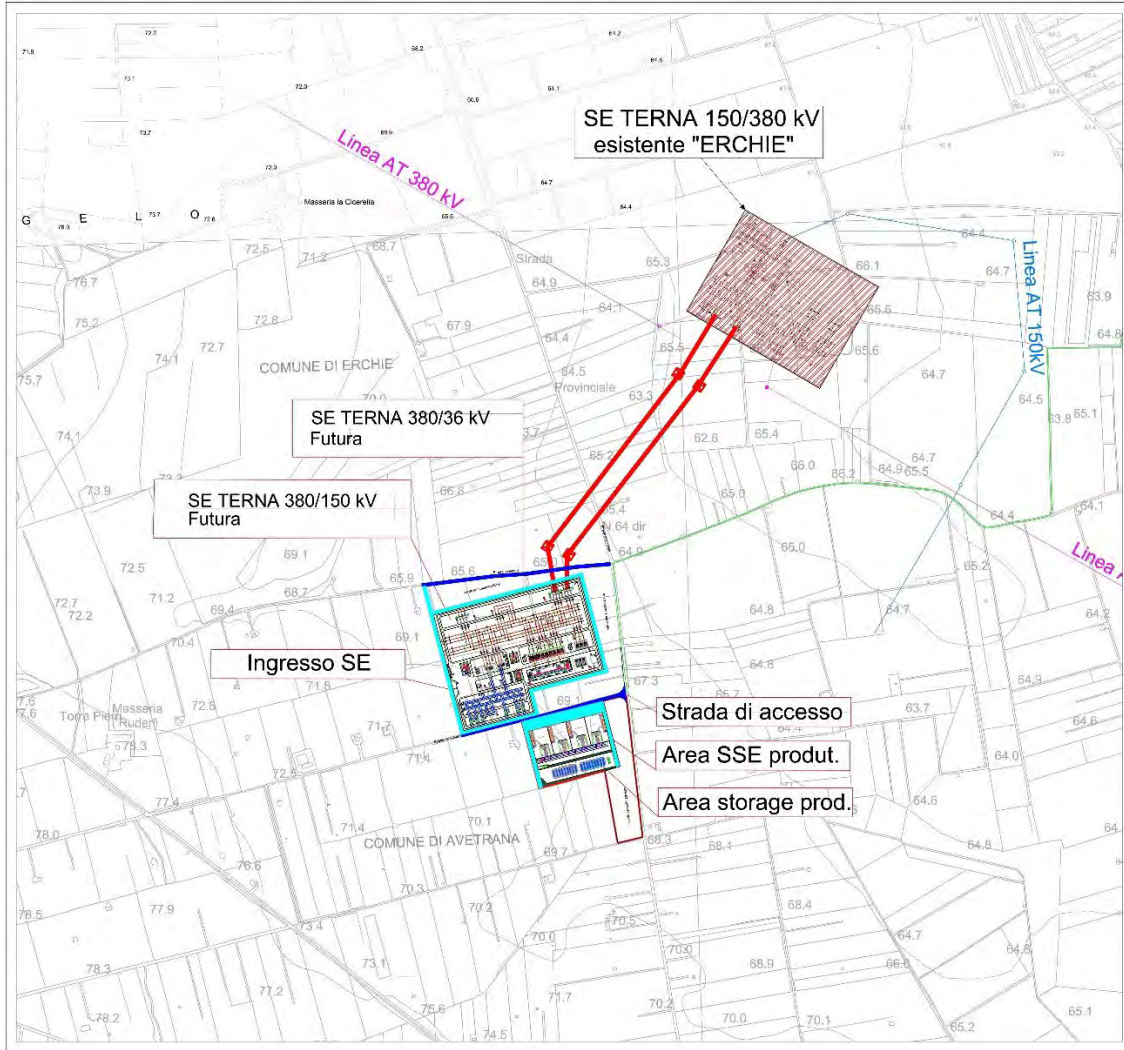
Planimetria SE SATELLITE : Sezione 380/150 kV e sezione 380/36 collegata con la SSE produttori
